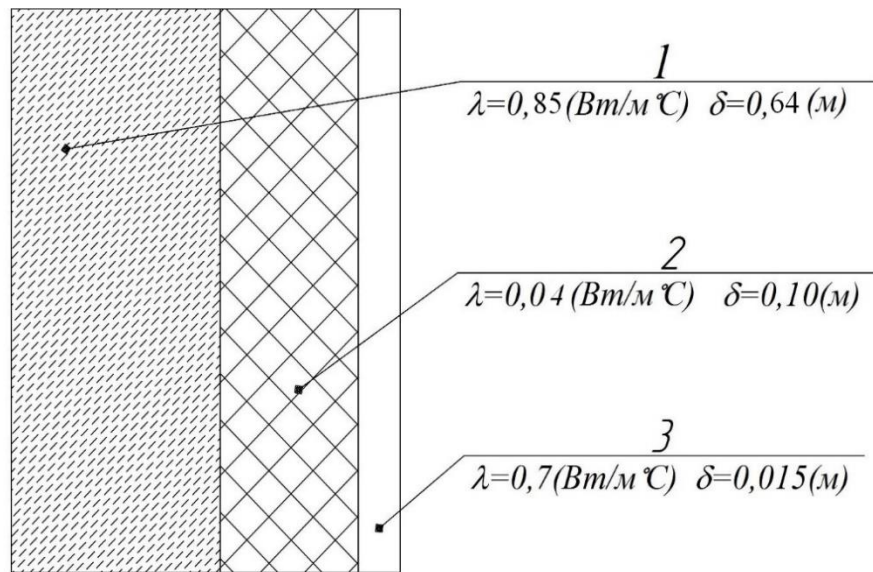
Схема утеплення зовнішньої стіни будівлі шаром мінеральної вати: 1- шар силікатної цегли, 2-шар утеплювача, 3- штукатурка.
